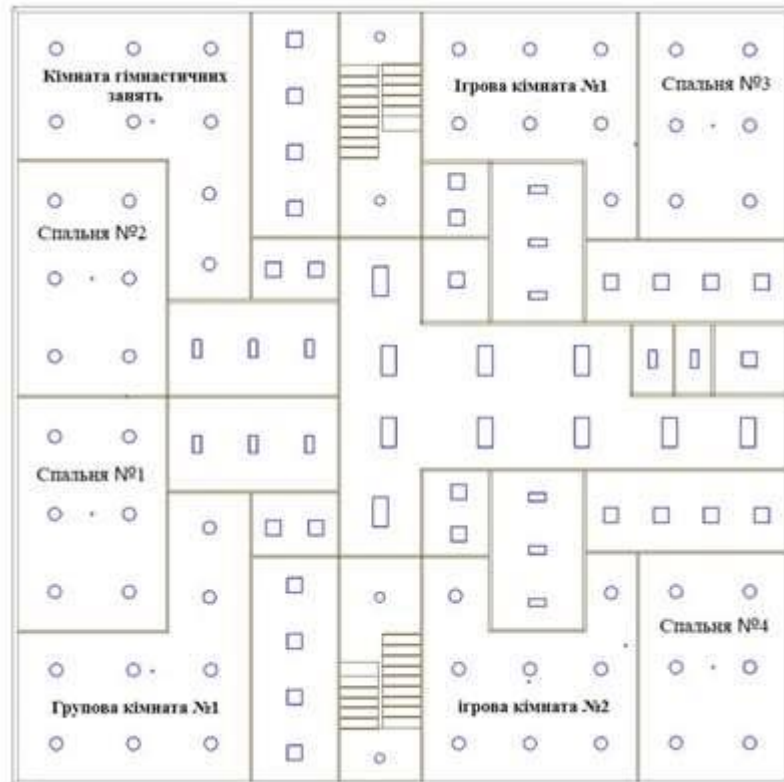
План роцташування світильників у першій половині будівлі садочка.
